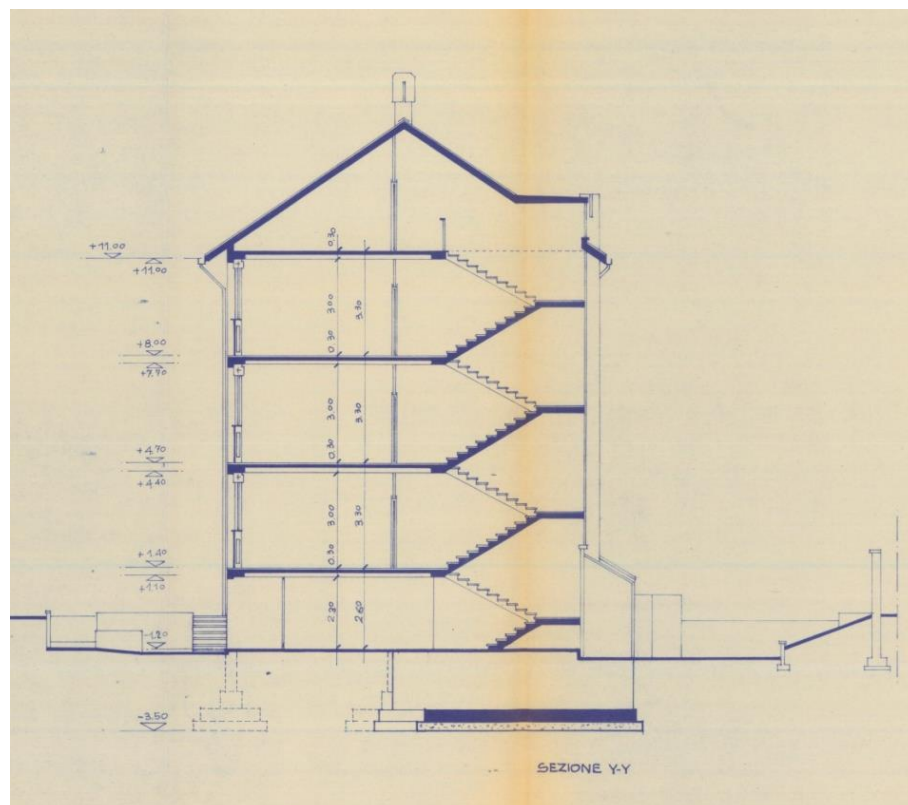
, Sezione Y-Y'; scansione progetto originale
